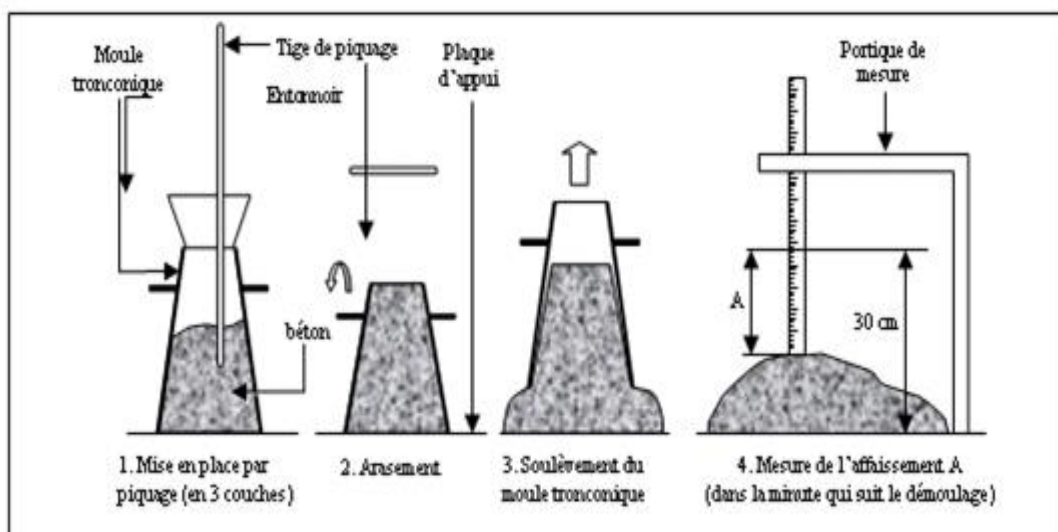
Essai d'affaissement au cône d'Abrams
